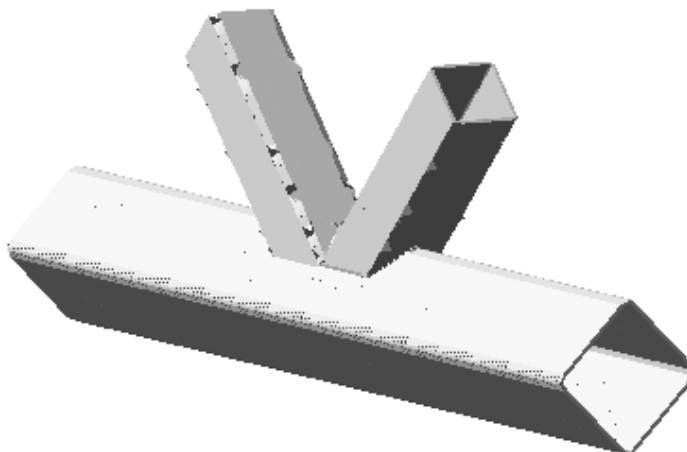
К-образный узел фермы из ГСП с присоединением раскосов к ребру квадратной трубы нижнего пояса [3]
